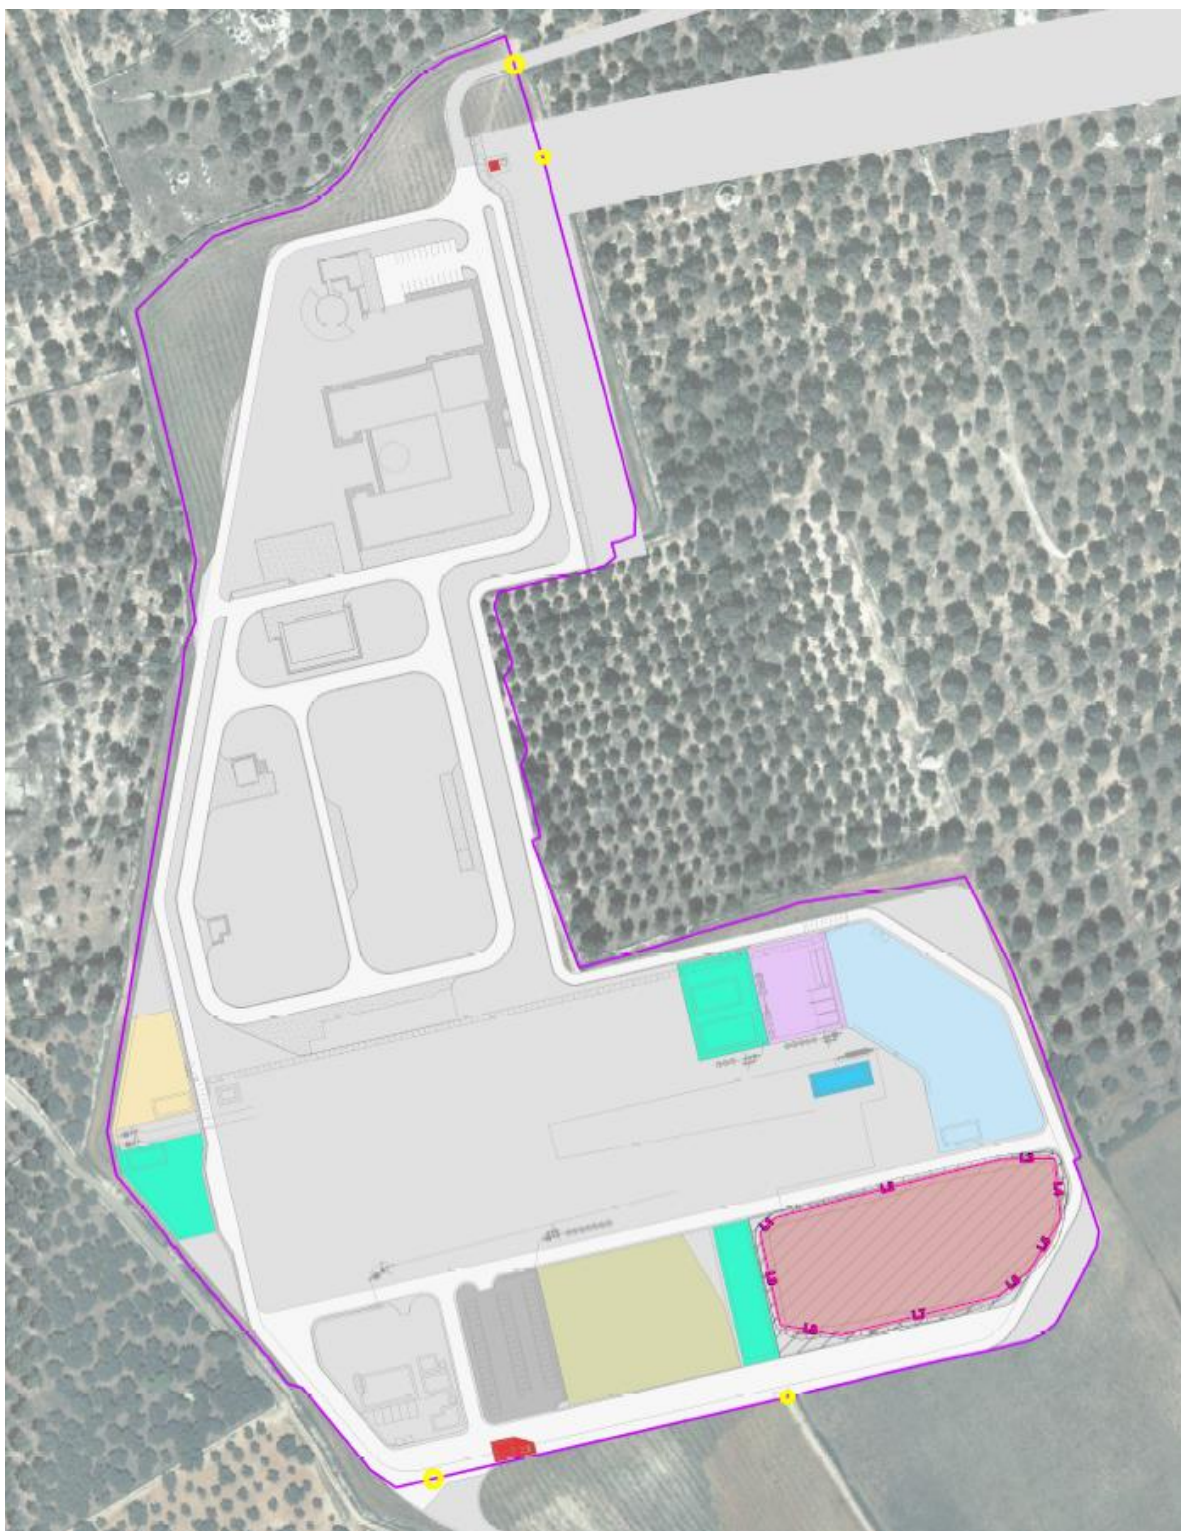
Layout dell'area di cantiere del PRT con indicazione del cumulo di Top Soil
